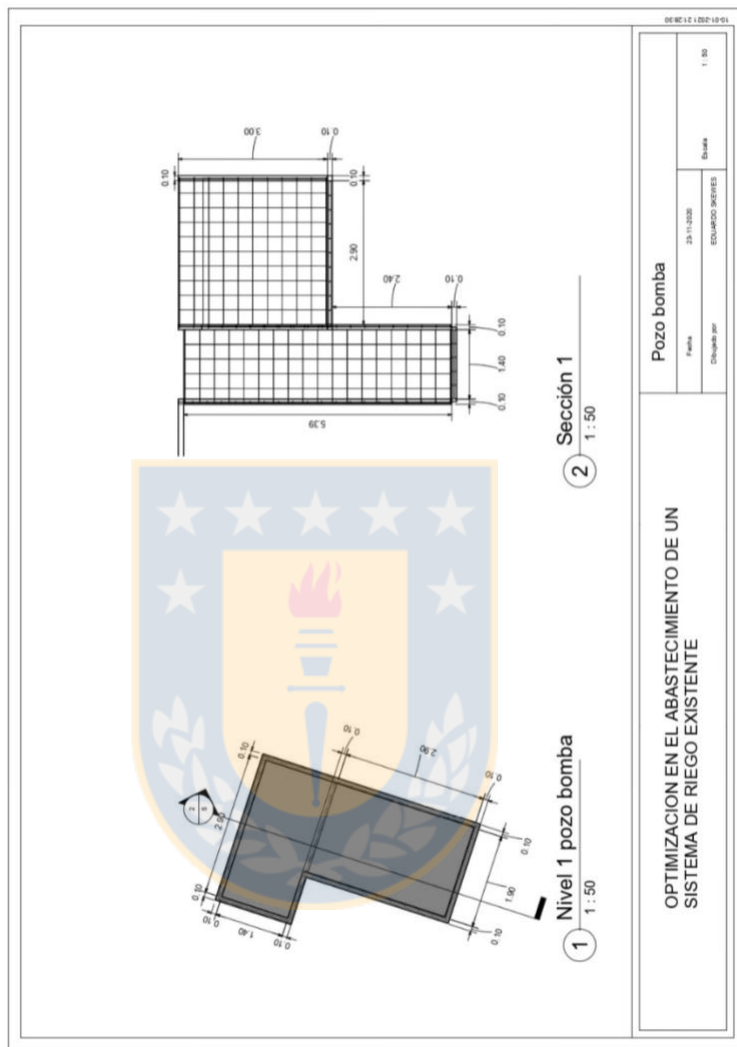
Plano planta sala de bombeo. Fuente: Elaboración propia.
